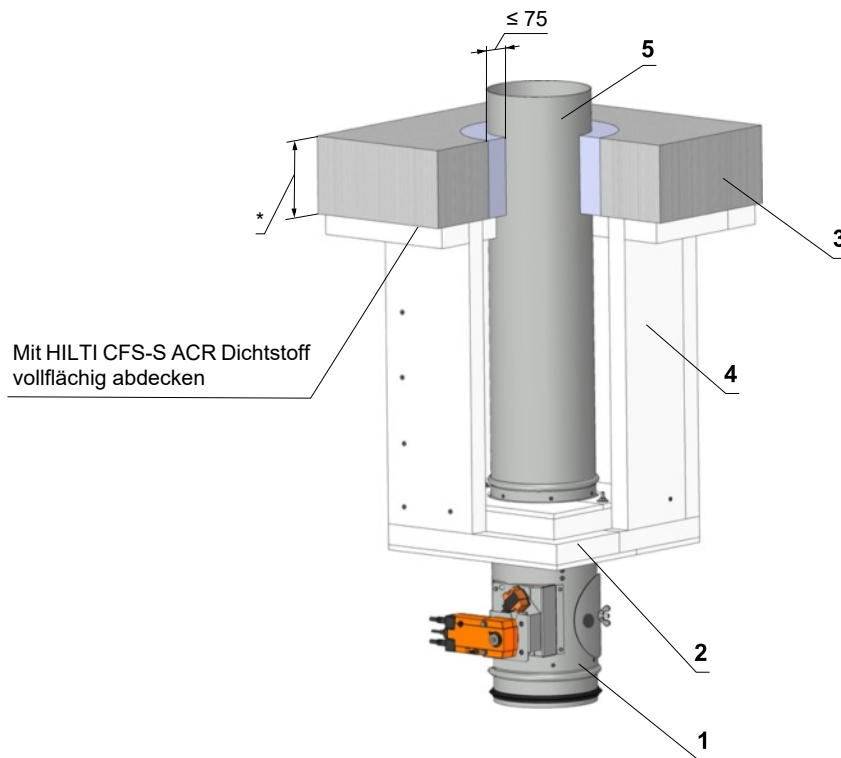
Außerhalb der massiven Deckenkonstruktion - Einbaurahmen R6 mit Isolierung mit Zement-Kalk-Platten
